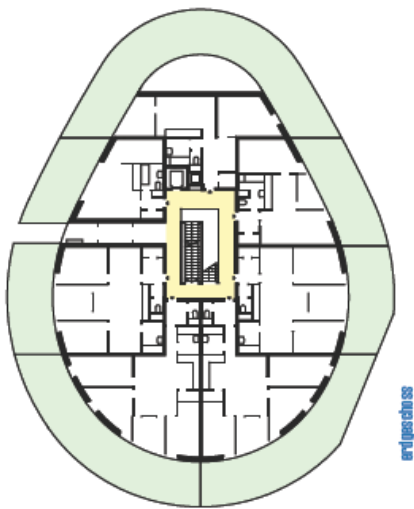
Grundriss Passivhaus (Quelle: Architekt Lautner)
